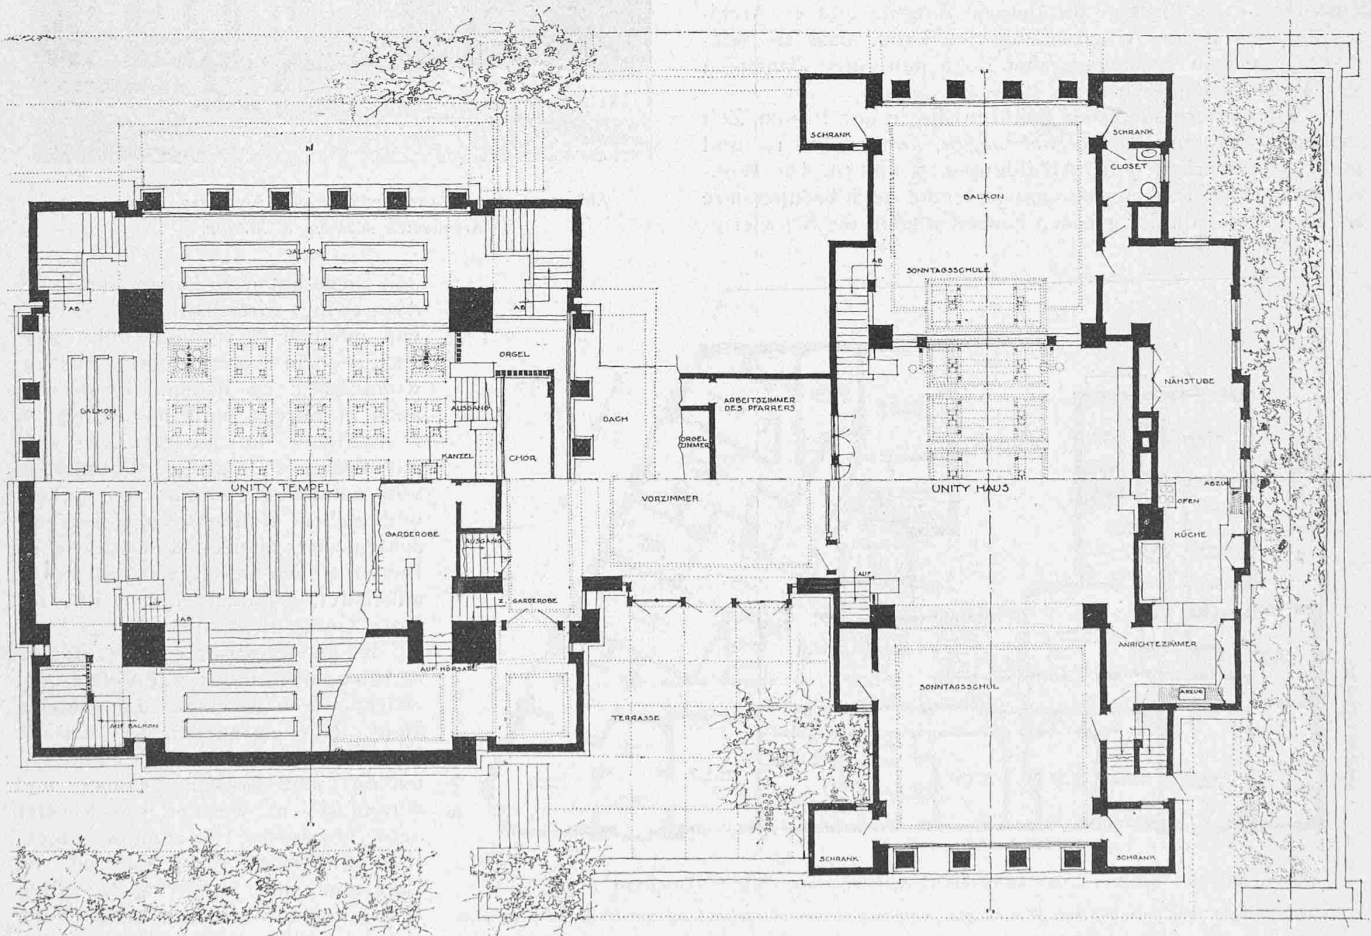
Grundriss vom Untergeschoss, Haupt- und Obergeschoss des «Unity Temple» in Oak Park, Ill. — Masstab etwa 1 : 250.
